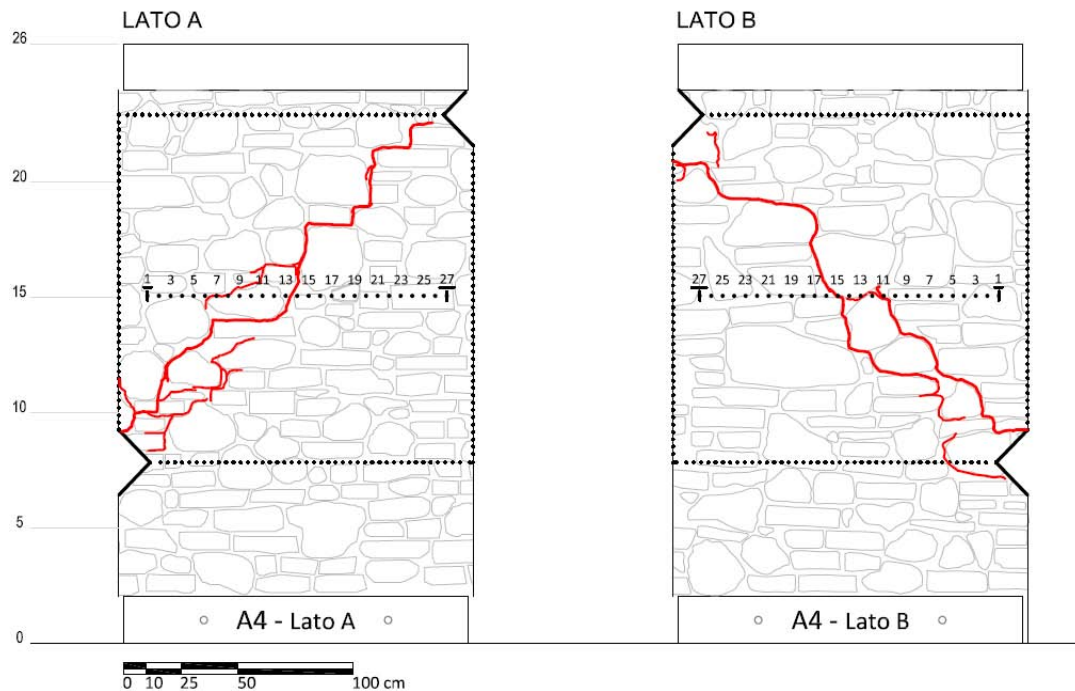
Prospetto della disposizione dei punti di acquisizione. In rosso le fessurazioni conseguenti all'esecuzione della prova di compressione diagonale (Zanchetta, 2013).
